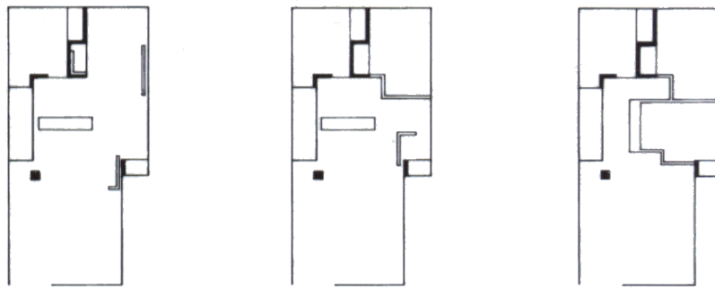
Grundrisse Appartementhaus Fukuoka
